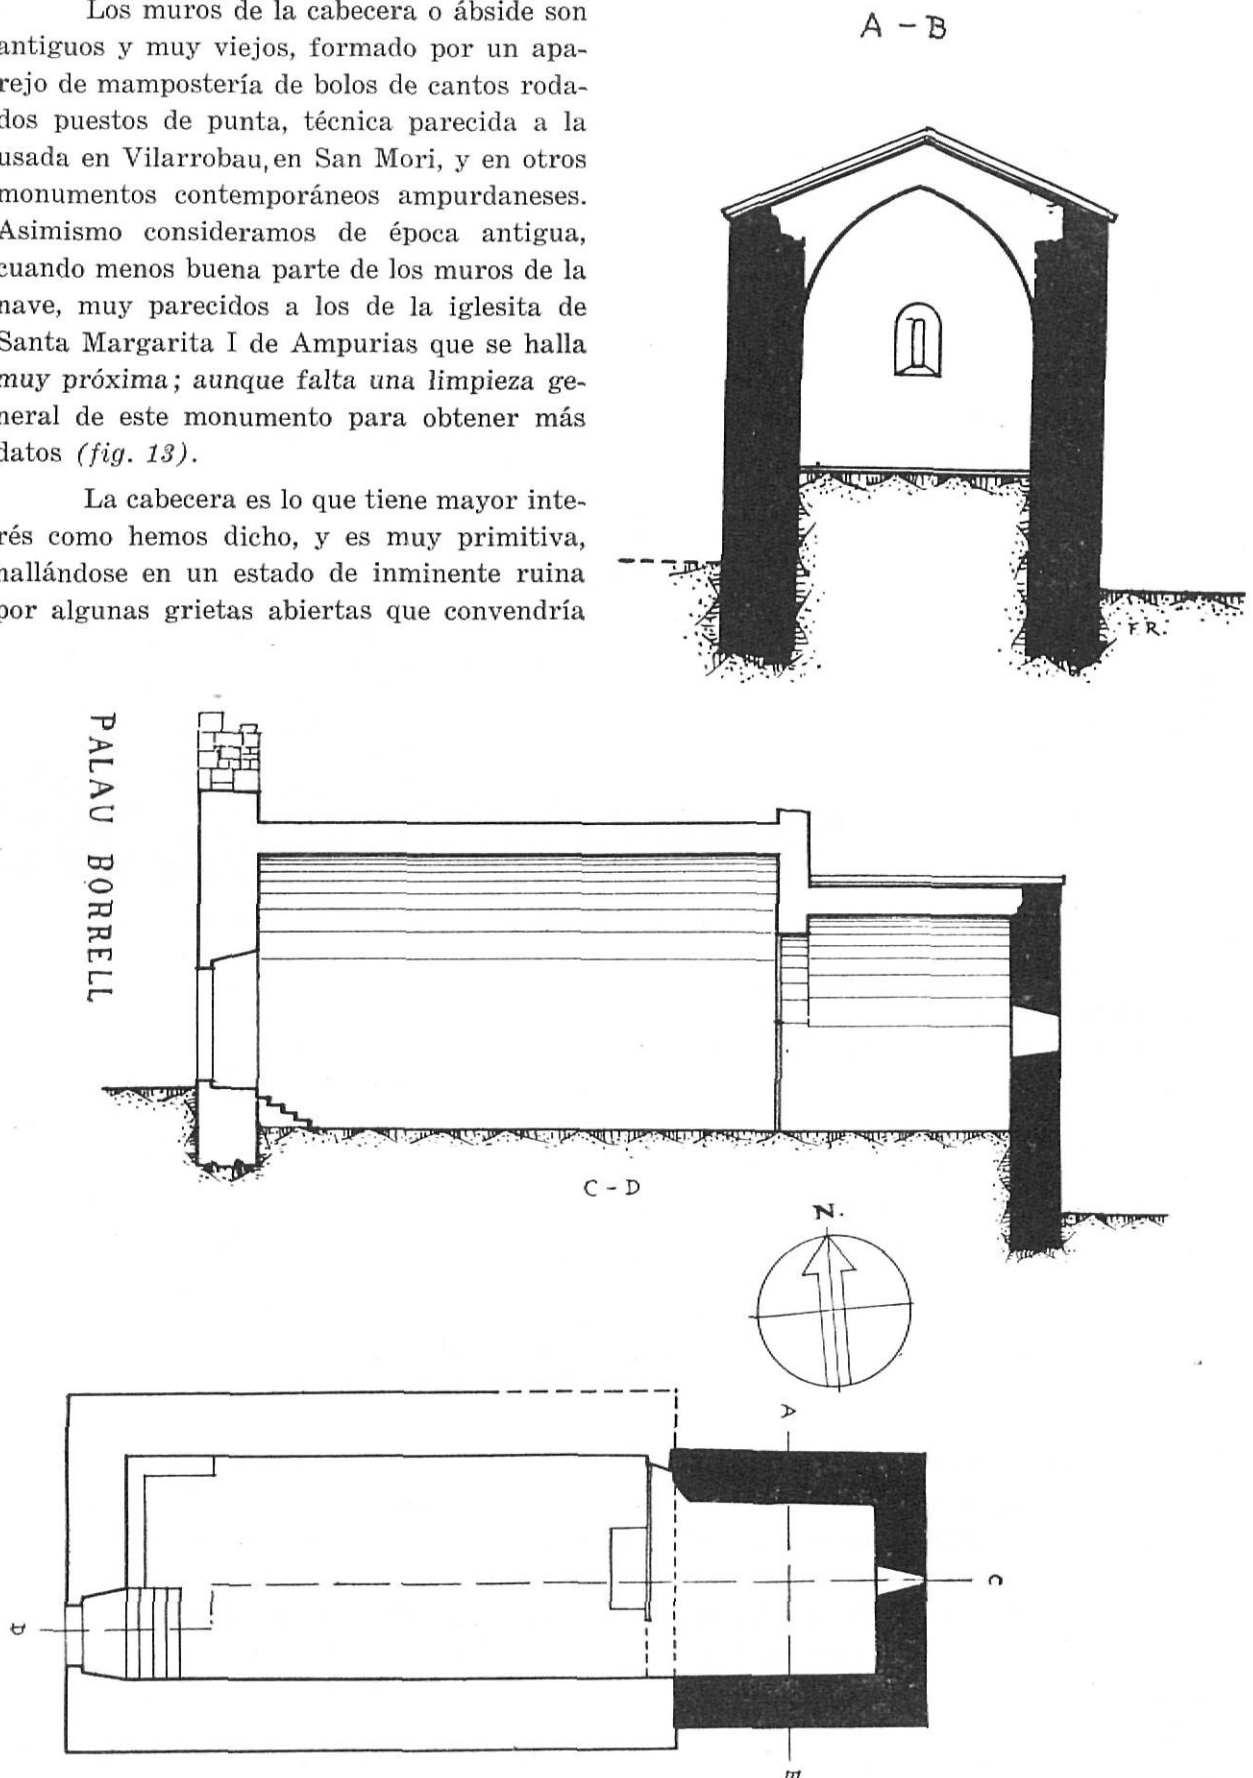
Planta, sección y alzado de Palau Borrell (según Rturó).
